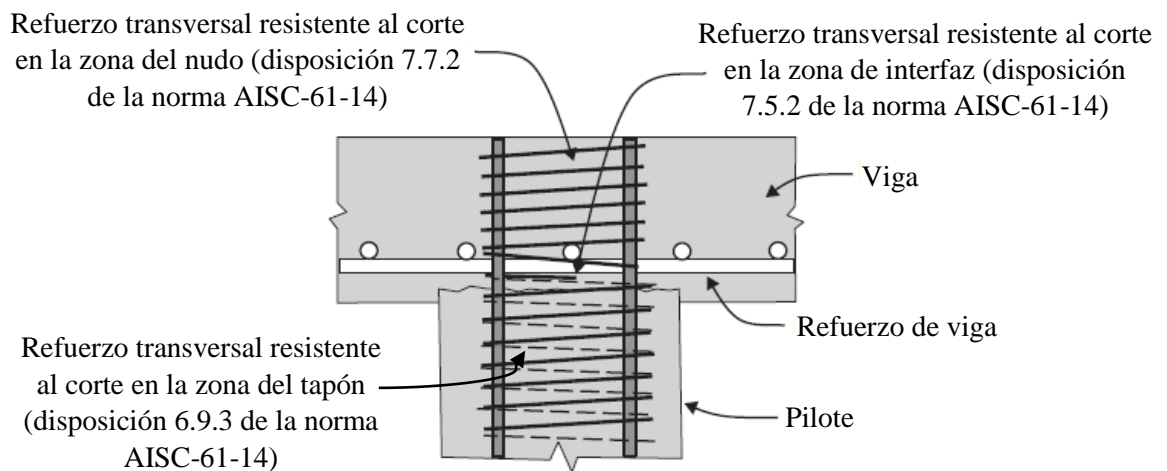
Detalle del refuerzo transversal en espiral para las distintas zonas de la conexión.
